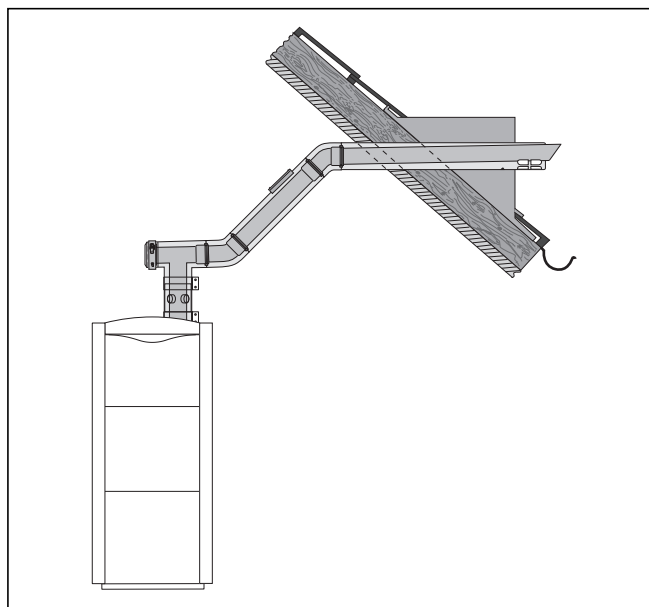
Montagebeispiel waagerechte Wand-/Dachdurchführung mit Revisions-T-Stück und Revisionsöffnung
